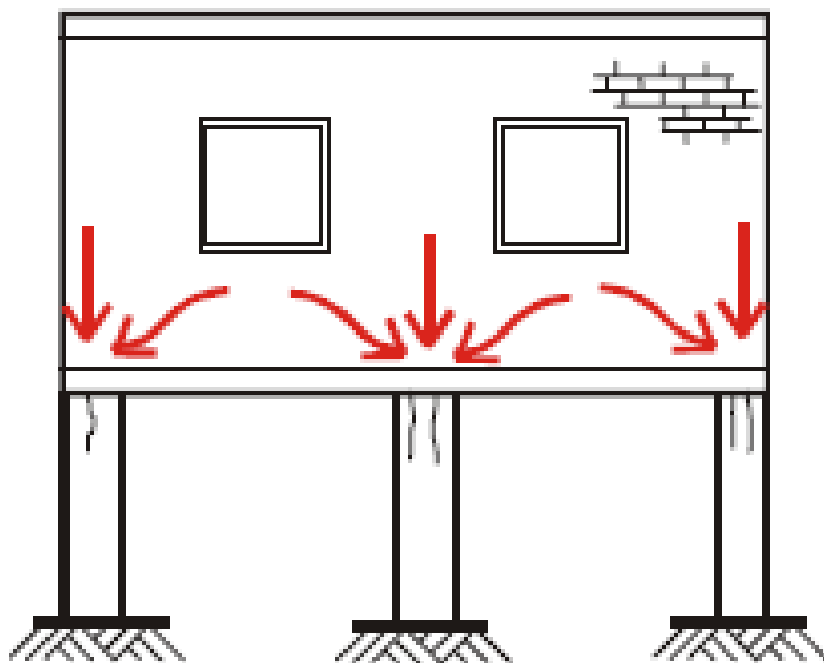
Ruptura sob um ponto de aplicação de carga concentrada excessiva.
